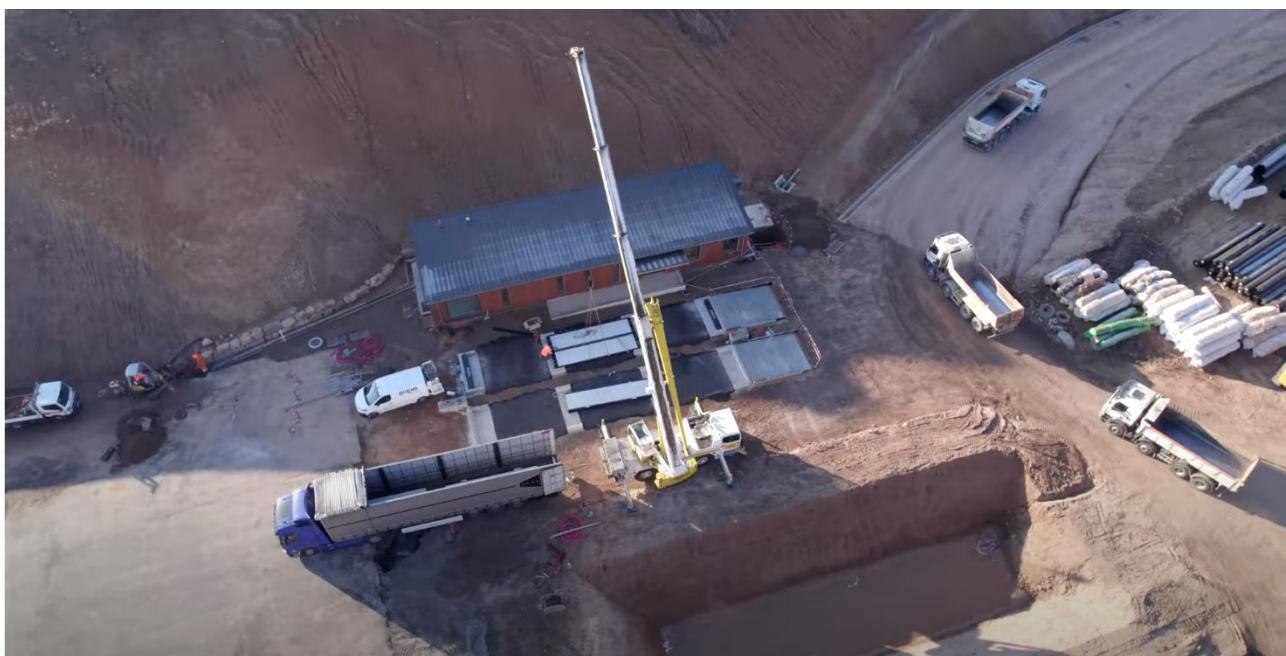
Création d'un plancher béton avec ossature bois pour l'enveloppe
